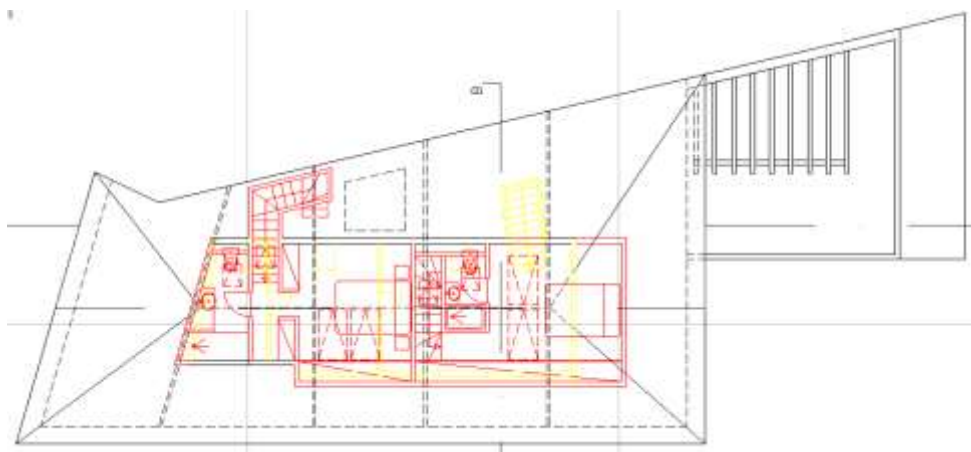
Planta de vermelhos e amarelos do vão do telhado
